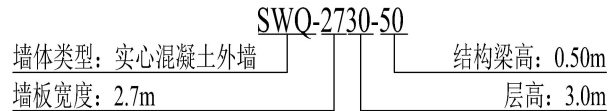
无洞口实心混凝土外墙编号规则示意图
